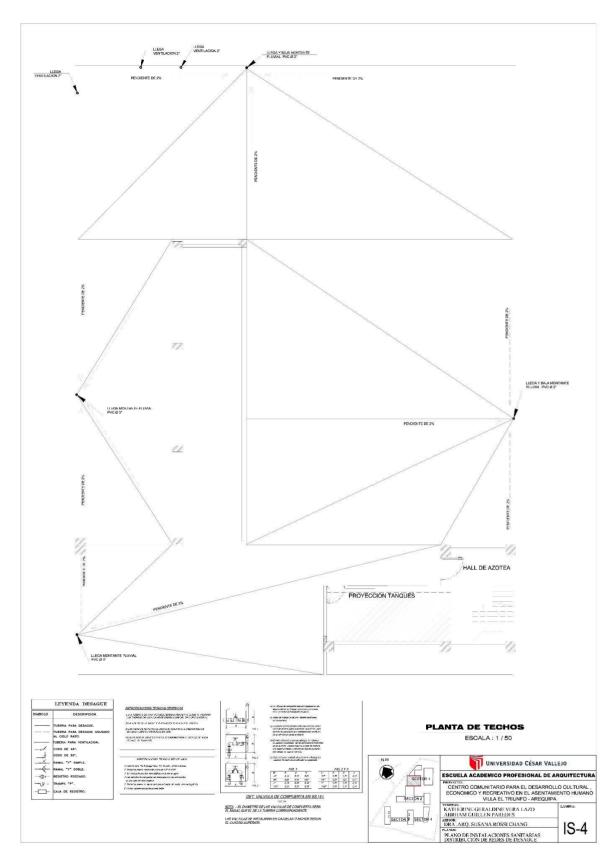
Plano de distribución de redes de desagüe y drenaje pluvial Planta de Techos - Elaboración propia
